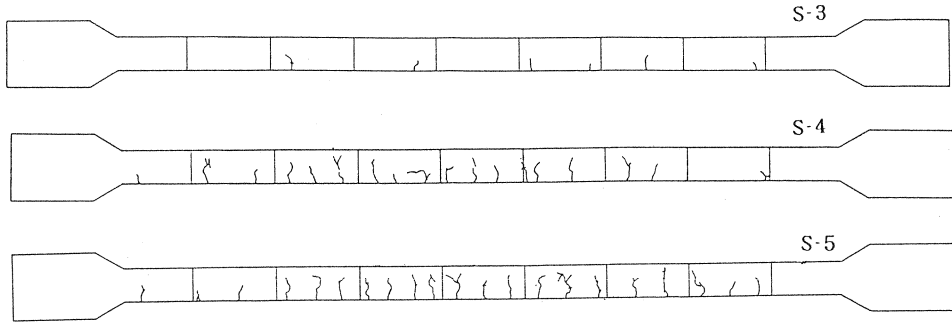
単純支持スラブ試験体のひび割れ状況
